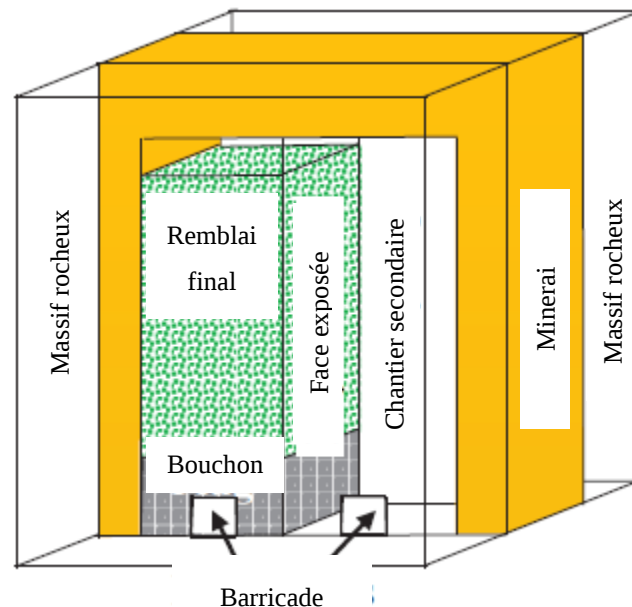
Coupe typique d'un chantier minier après excavation du chantier secondaire et présentation du bouchon (adaptée de Li, 2014b)
